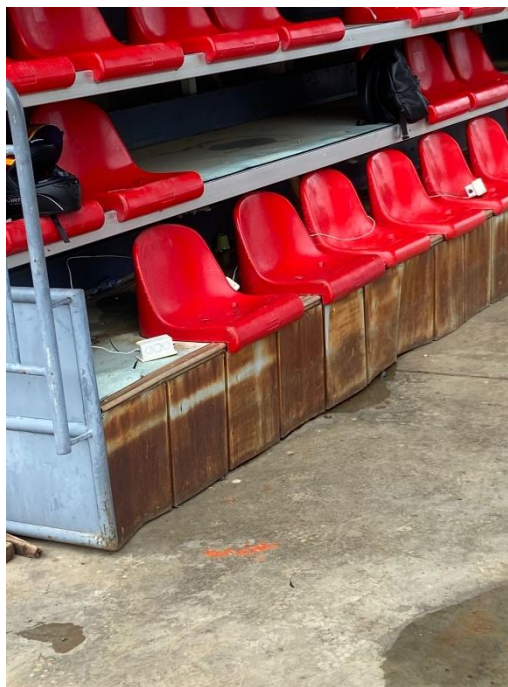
Falta de mantenimiento de estructura metálica de gradas. Zona 5. Fuente: Propia.
